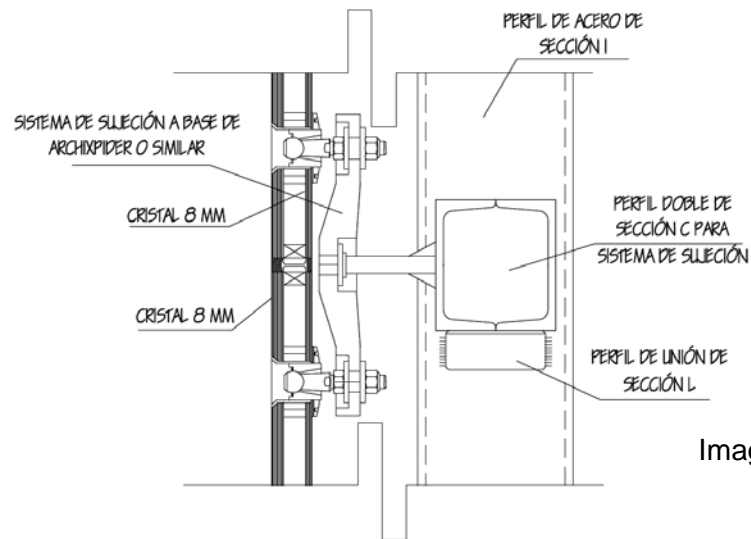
Detalle en alzado de colocación del sistema Archipider marca *KINETIC
